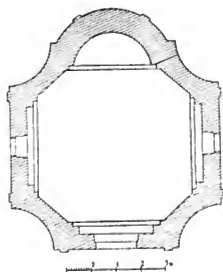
Wysoka. Grundriss des Beinhauses.
